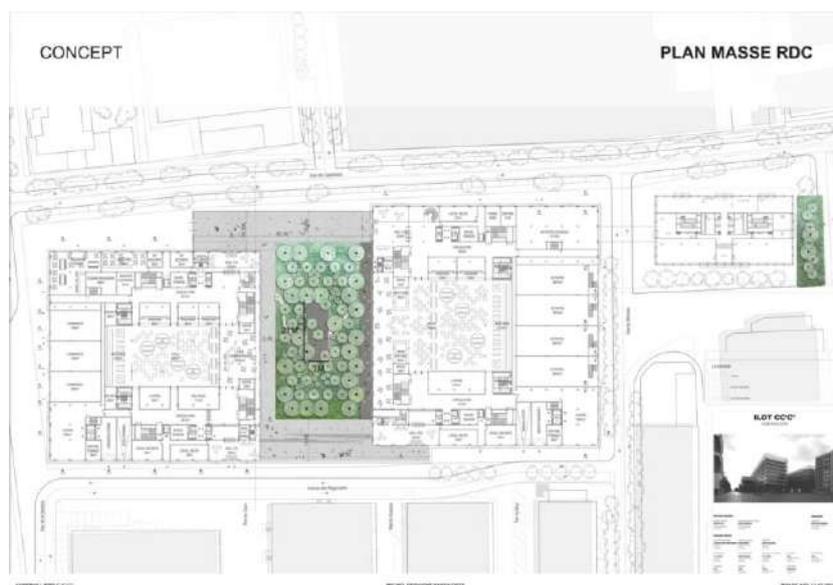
Plan masse paysager (Source: Michel DESVIGNE PAYSAGISTE)
